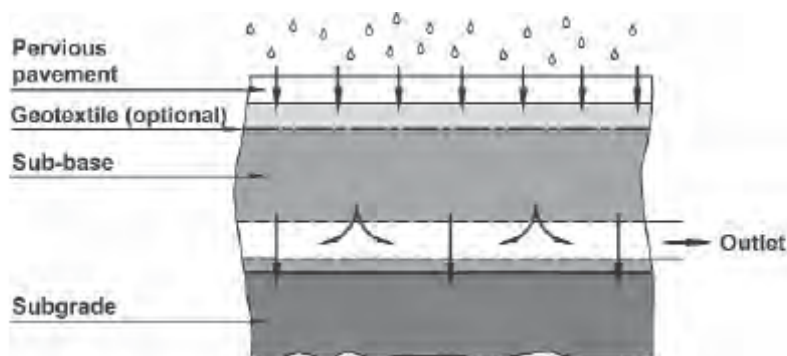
Pavimento poroso Tipo B com infiltração parcial e uso de drenos
